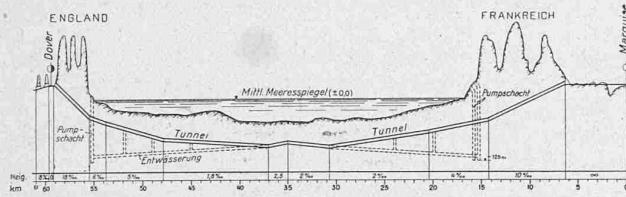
und 2. Lageplan und Längenprofil des Kanaltunnels.
